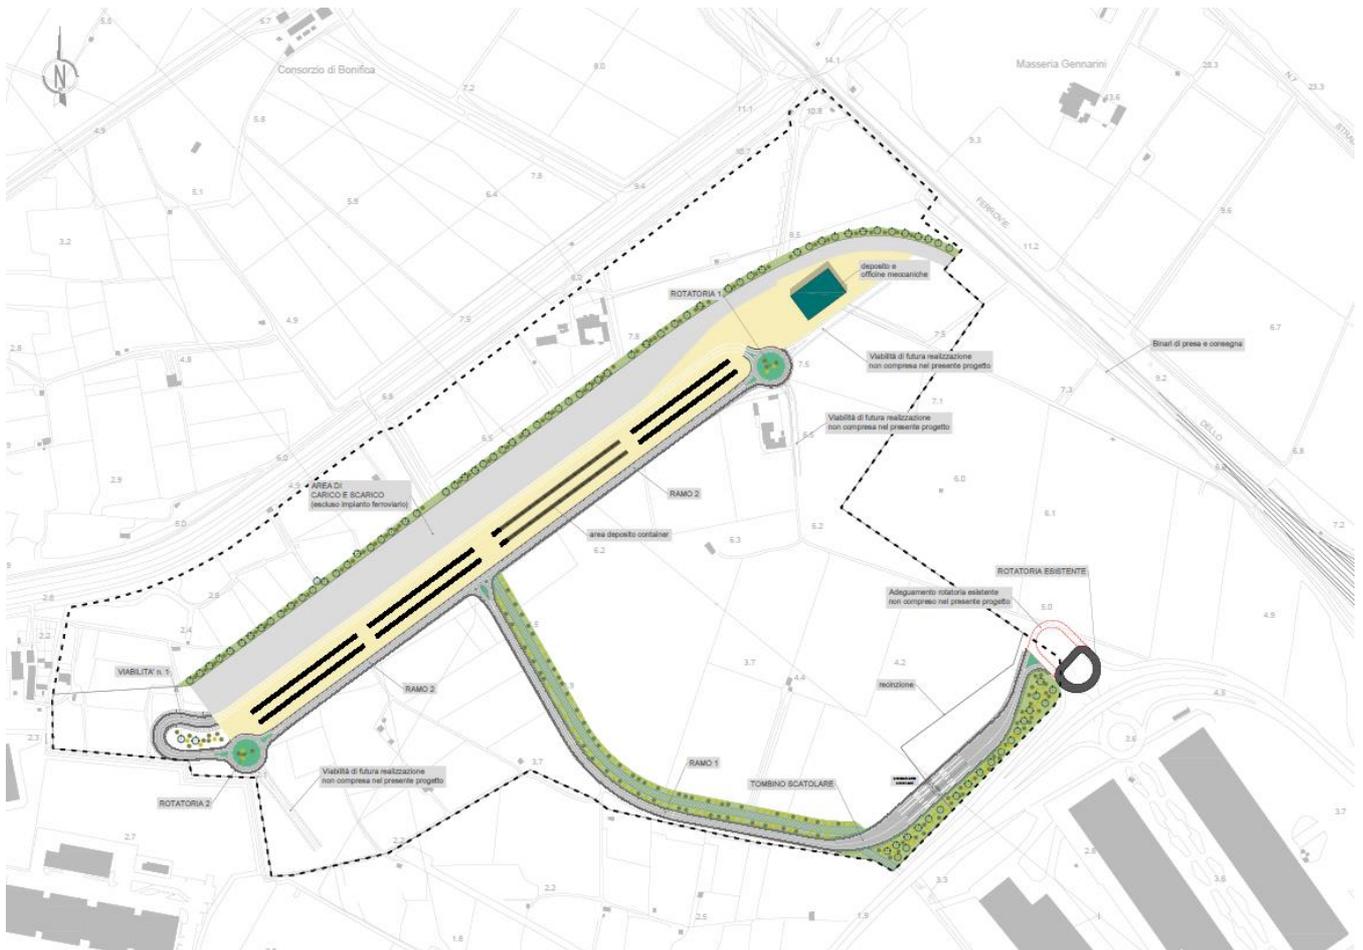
Aree a Verde Planimetria Stralcio 1 Eco Industrial Park
